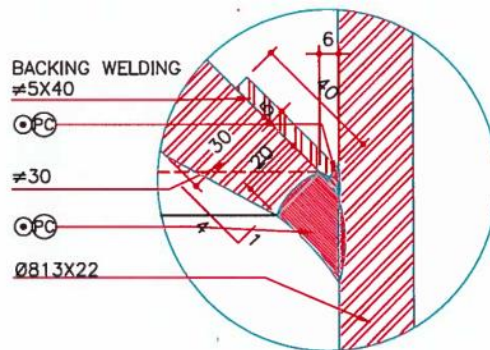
Detalle de soldadura de anillo a pilote
